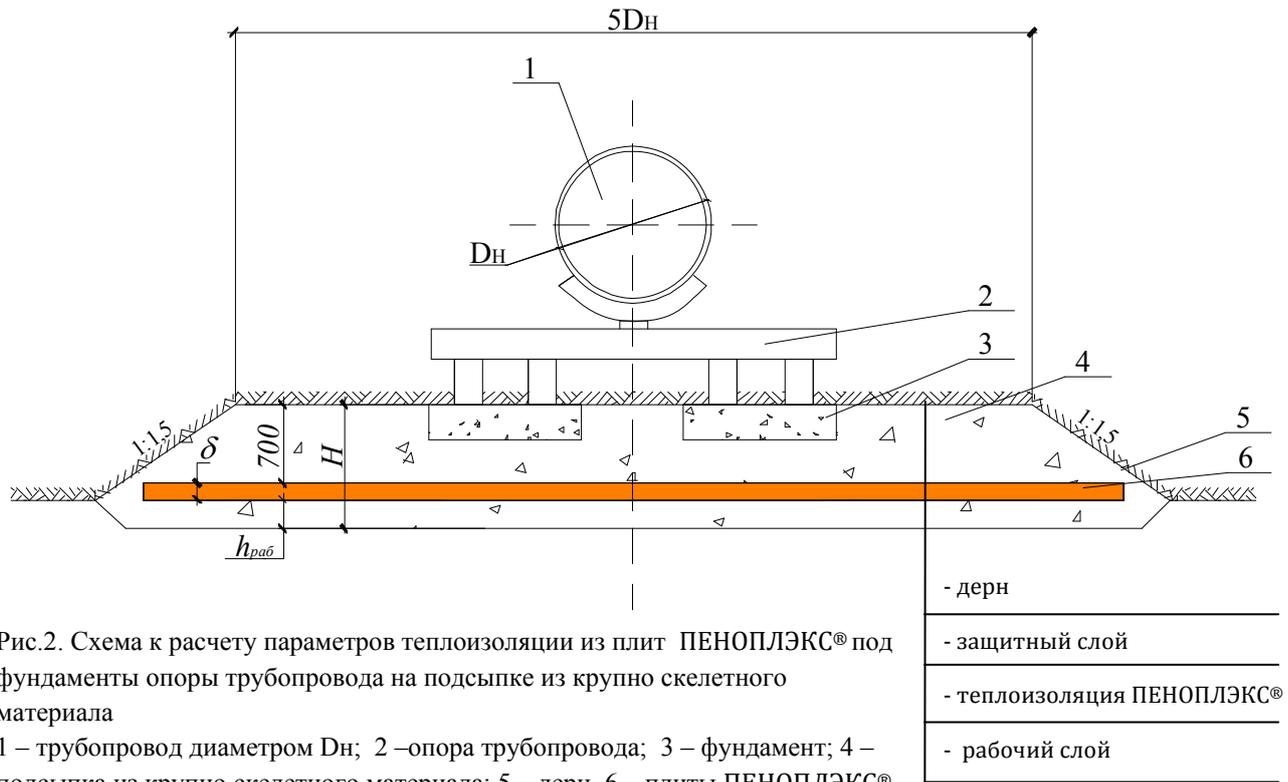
Схема к расчету параметров теплоизоляции из плит ПЕНОПЛЭКС® под фундаменты опоры трубопровода на подсыпке из крупно скелетного материала
